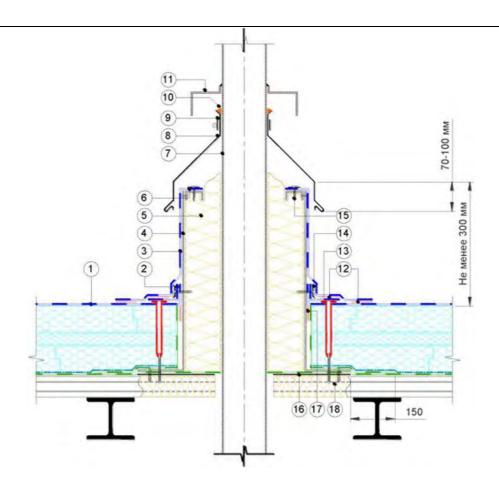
Примыкание кровельного ковра к горячей трубе:
